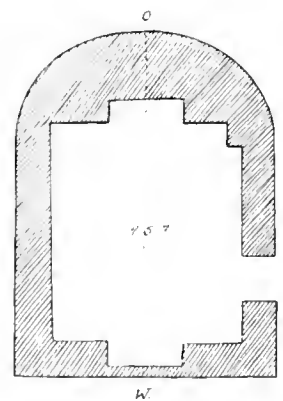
Grundriss einer Kapelle bei Sarikawak.
